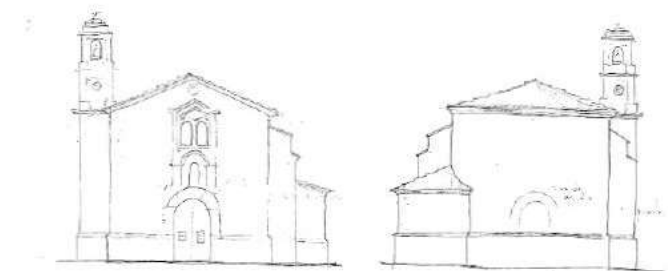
Alzado del acceso principal al sur y alzado al norte con el presbiterio.
